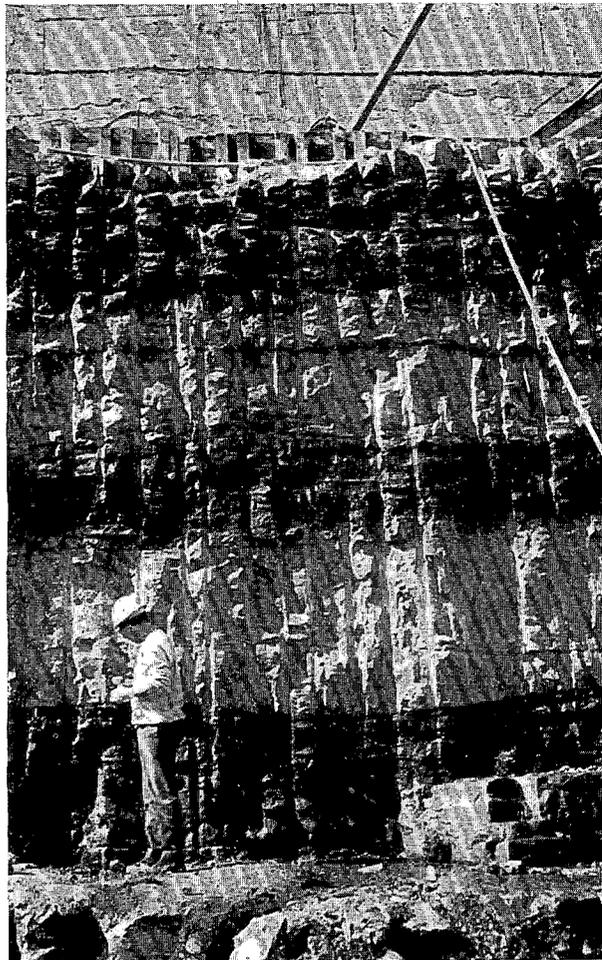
^a — Presa de Mequinenza. Detalle de las excavaciones con precorte.
